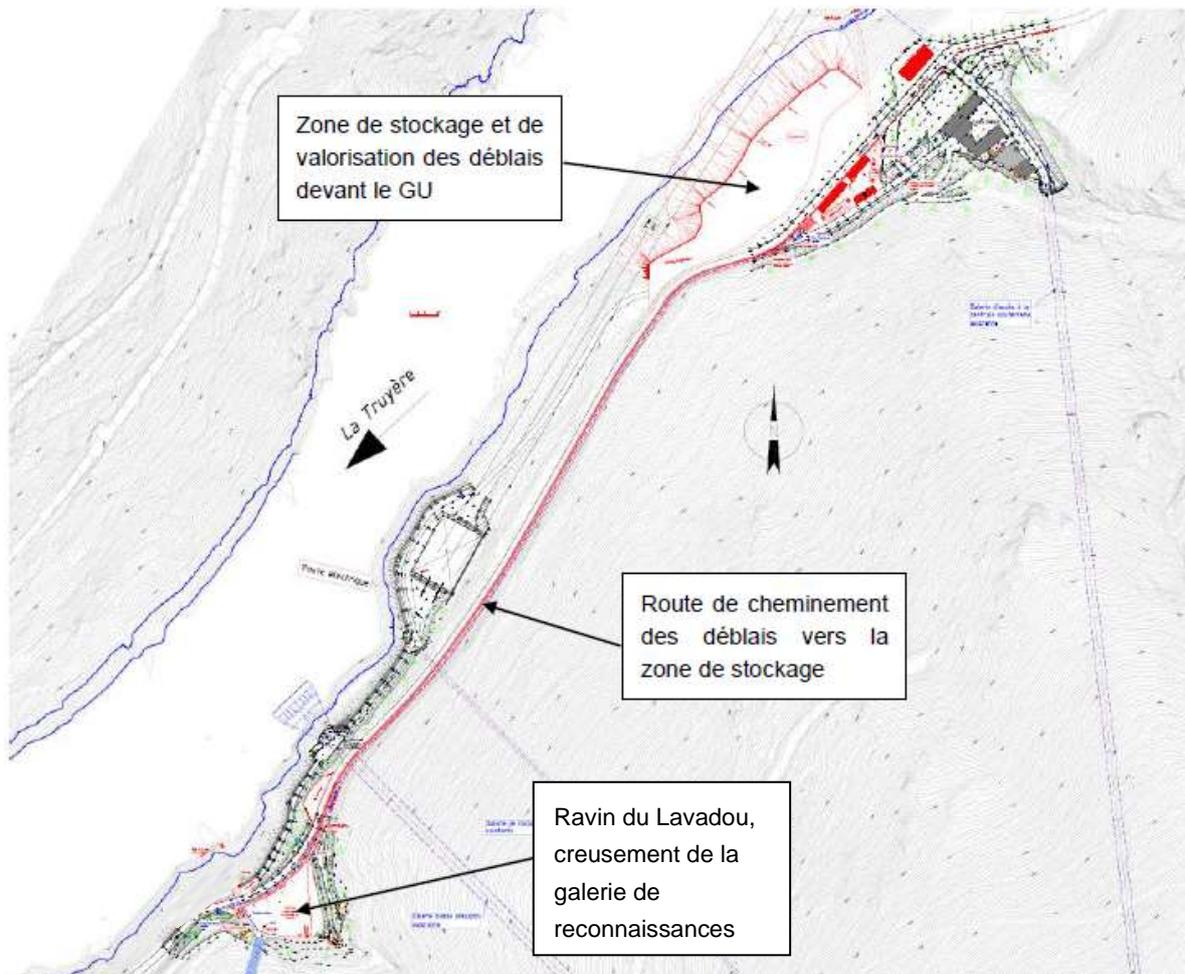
Plan général des zones de chantier des travaux de reconnaissances (Source : EDF)
